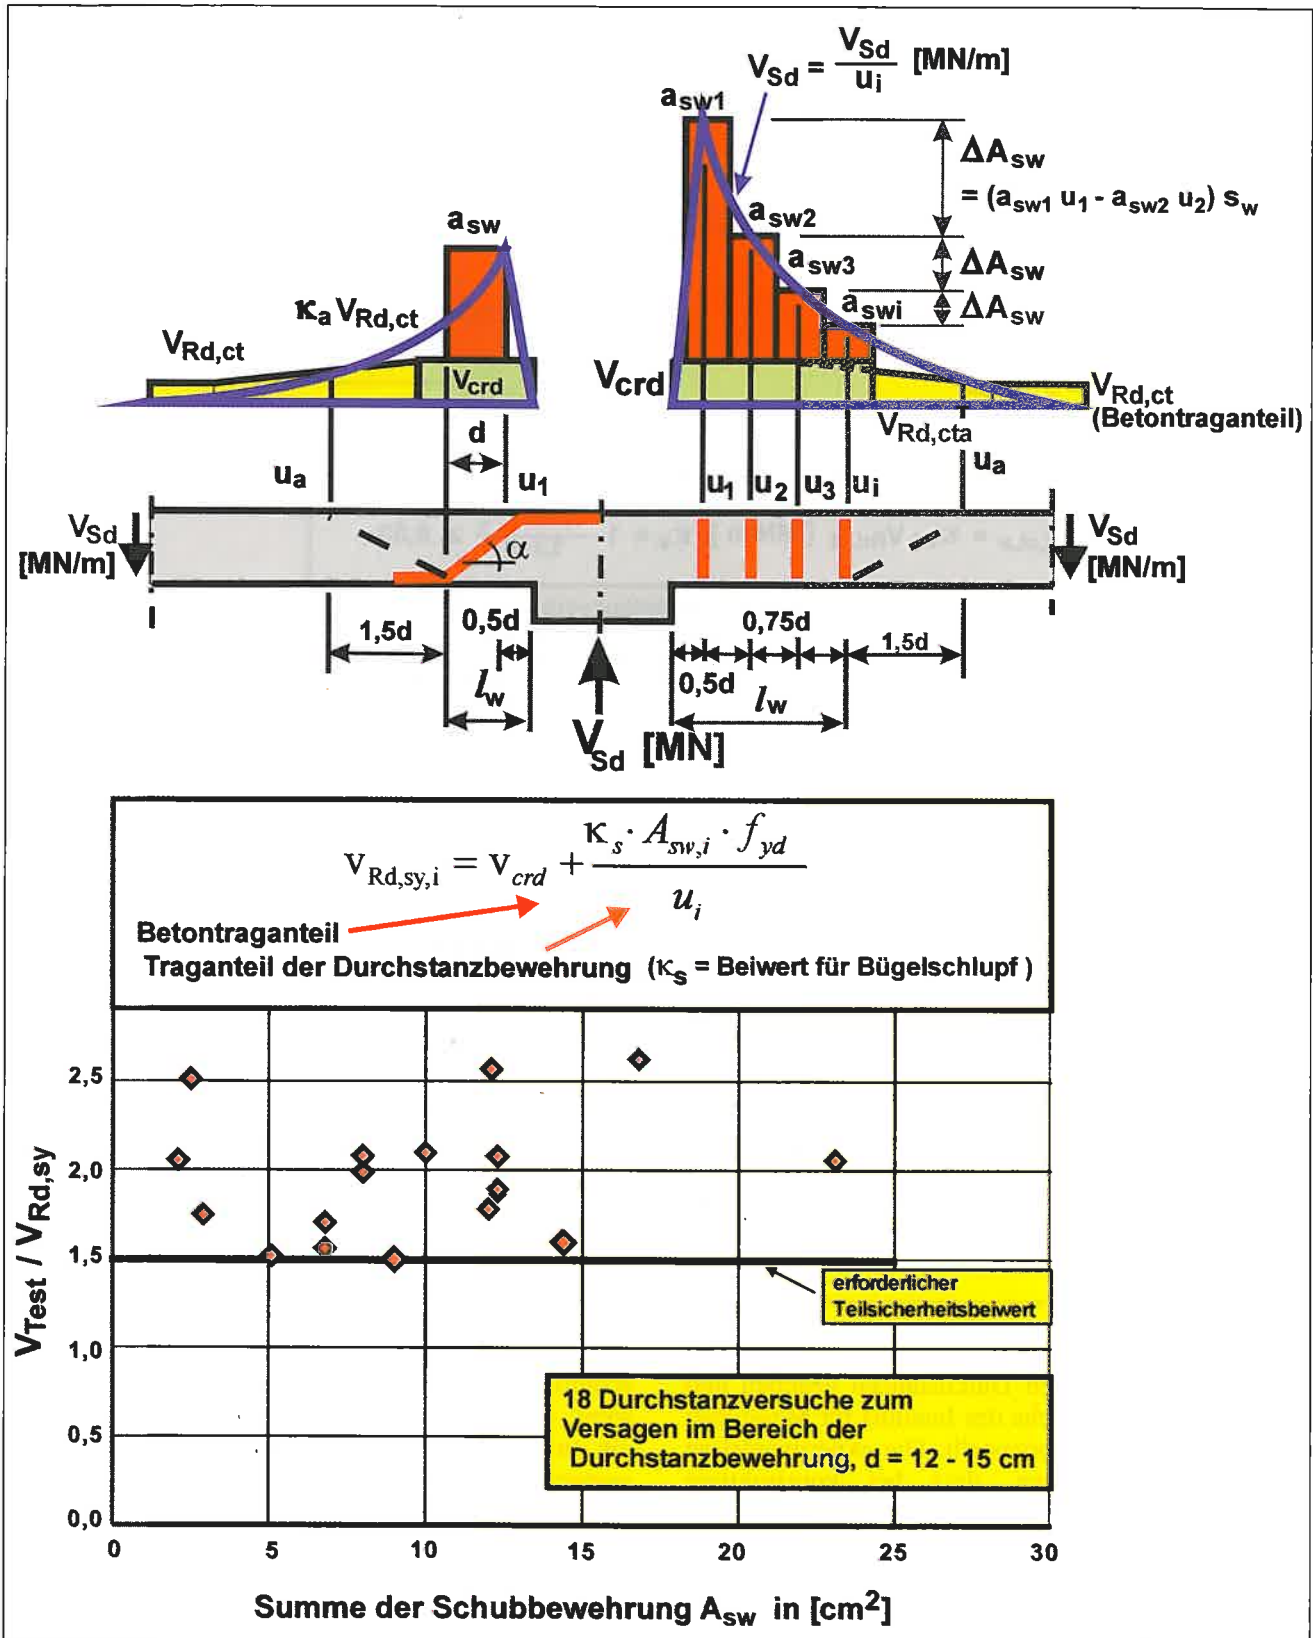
Bemessungsgleichung und Versuchsnachrechnung zum Bügelversagen im Durchstanzbereich
